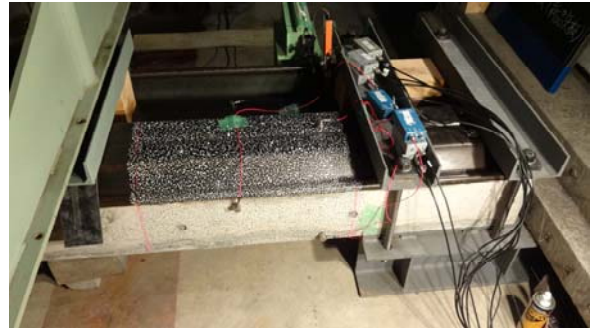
鋼矢板-コンクリート複合材の曲げ載荷試験状況
